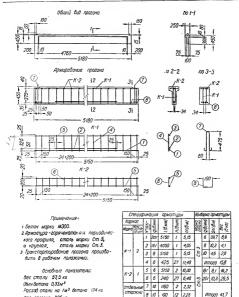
,34. Конструктивный чертеж прогона для перекрытия.
